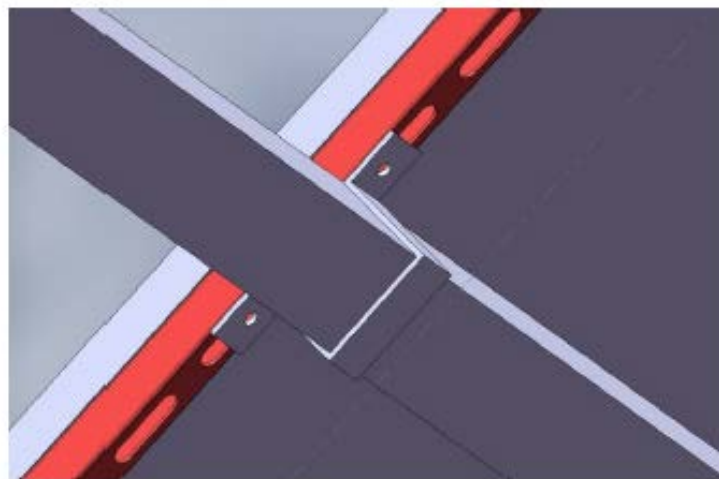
Conjunto panel-carril-correa, sujetos mediante la chapa de unión.
